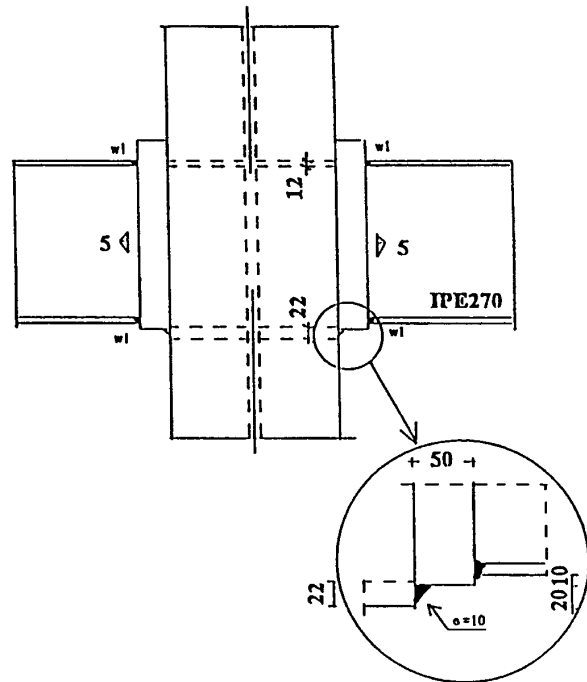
Assemblages soudés du spécimen WR
